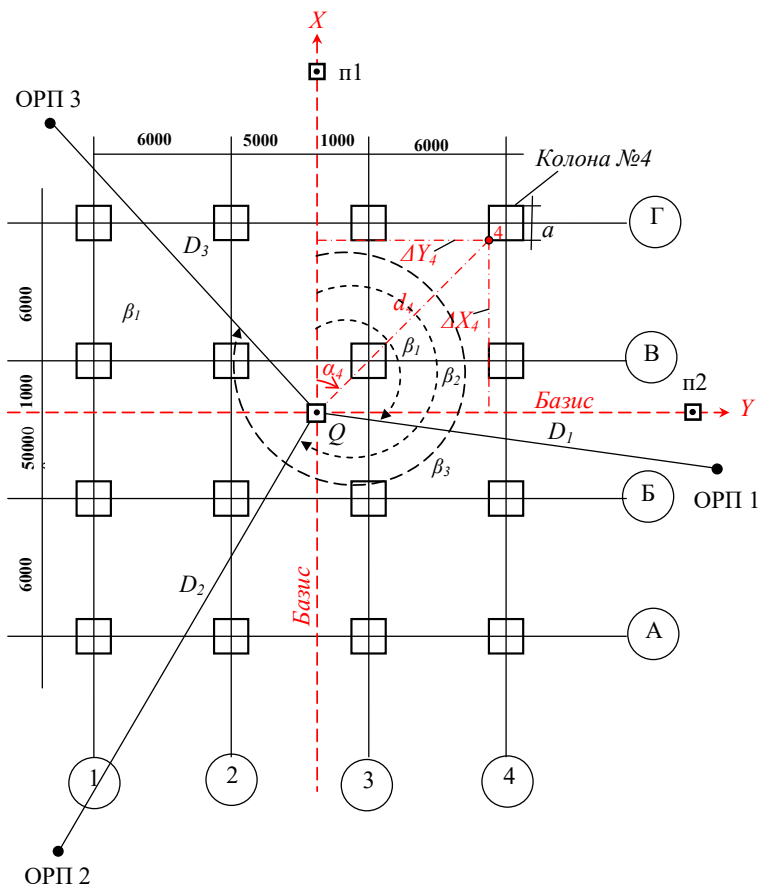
До розпланування будівельних конструкцій в системі координат будівлі
